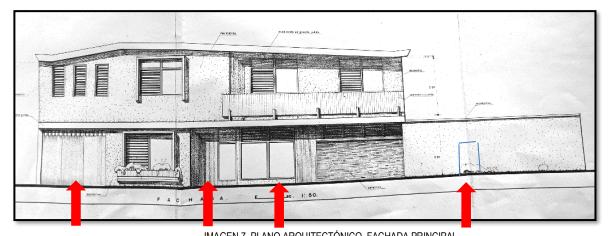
PLANO ARQUITECTÓNICO. FACHADA PRINCIPAL Plano arquitectónico Fachada principal y sus cuatro accesos. (Garaje, Principal, consultorio y jardín).
